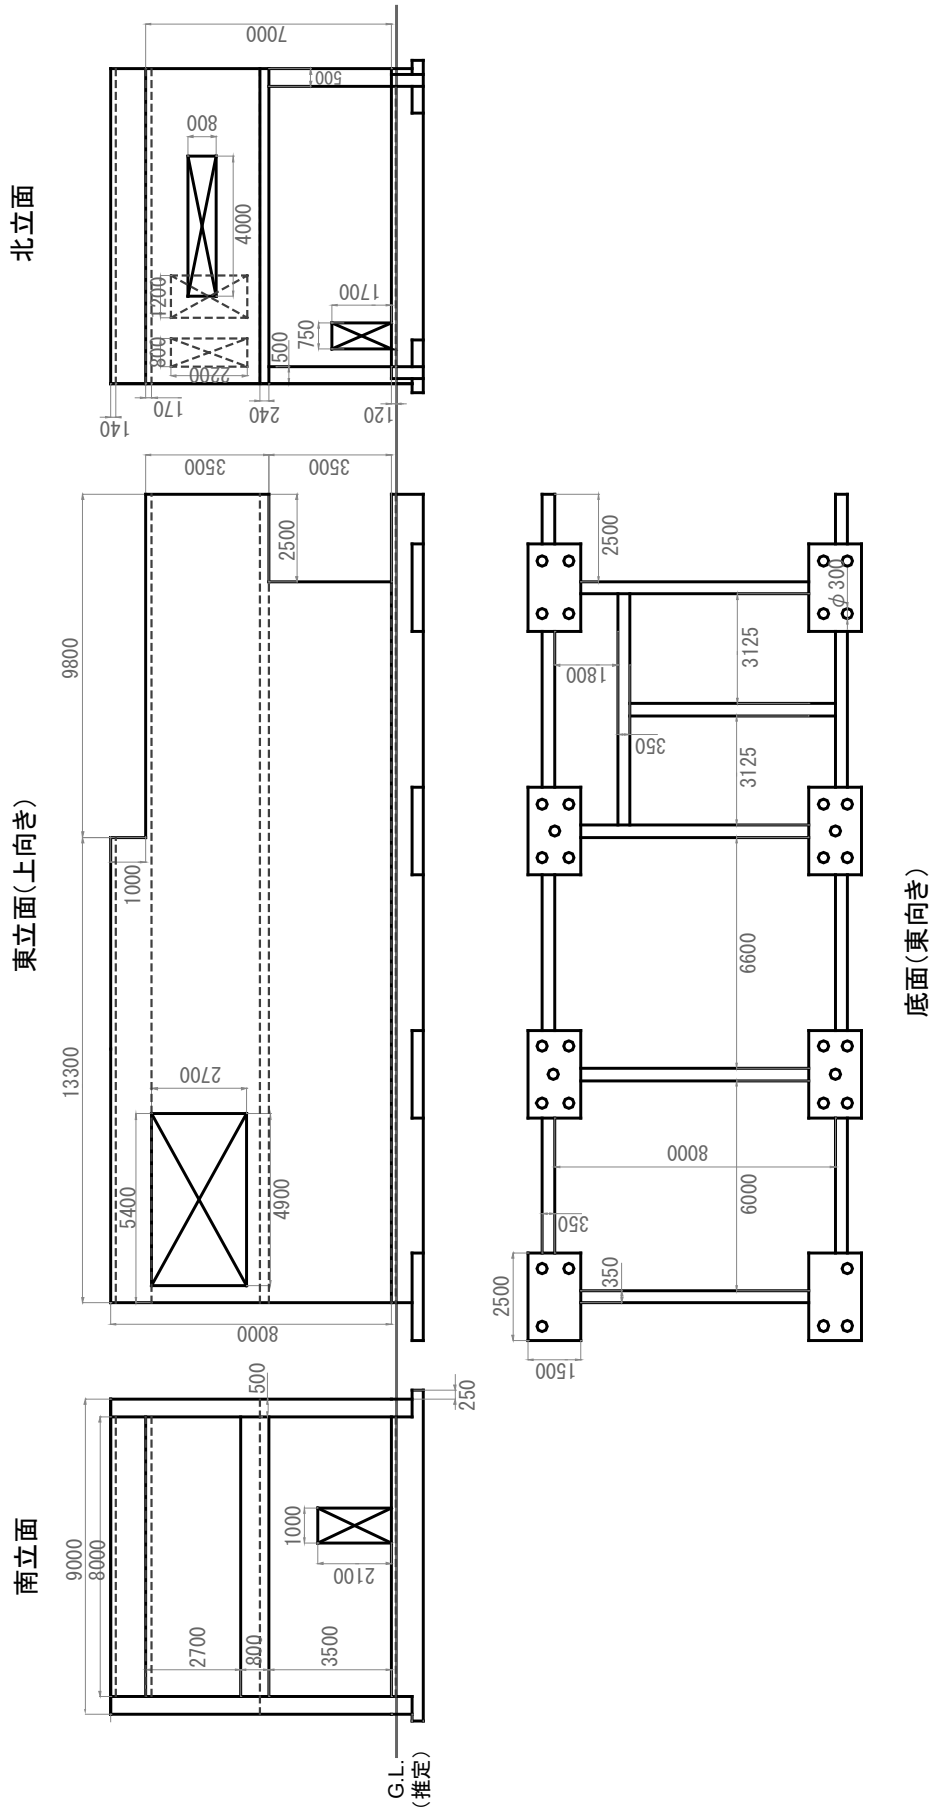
調査対象建物 立面図・見付図 (単位: mm)
